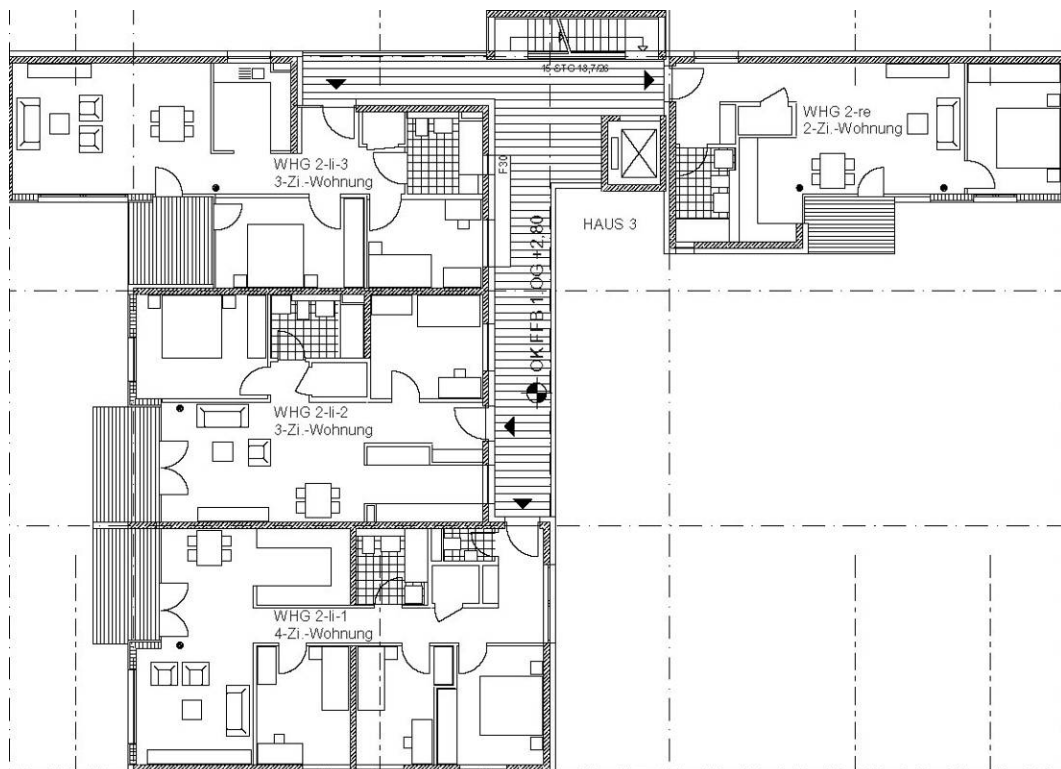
Ausschnitt Grundriss (Franz und Geyer Architekten)
